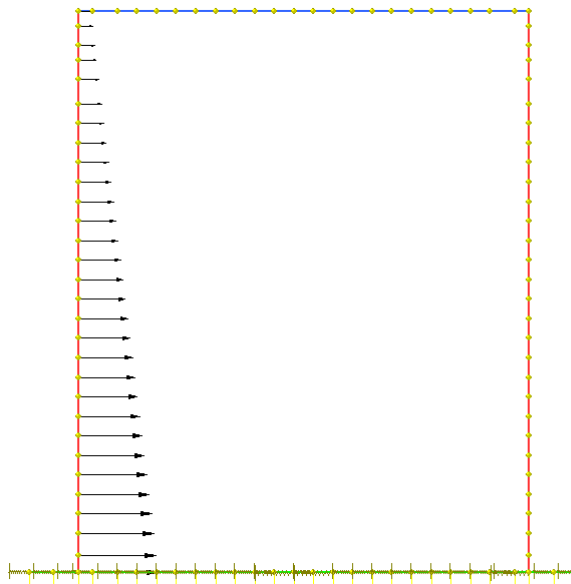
SPINTA A RIPOSO DELLE TERRE SUL PIEDRITTO SINISTRO FALDA BASSA (CDC 6)
